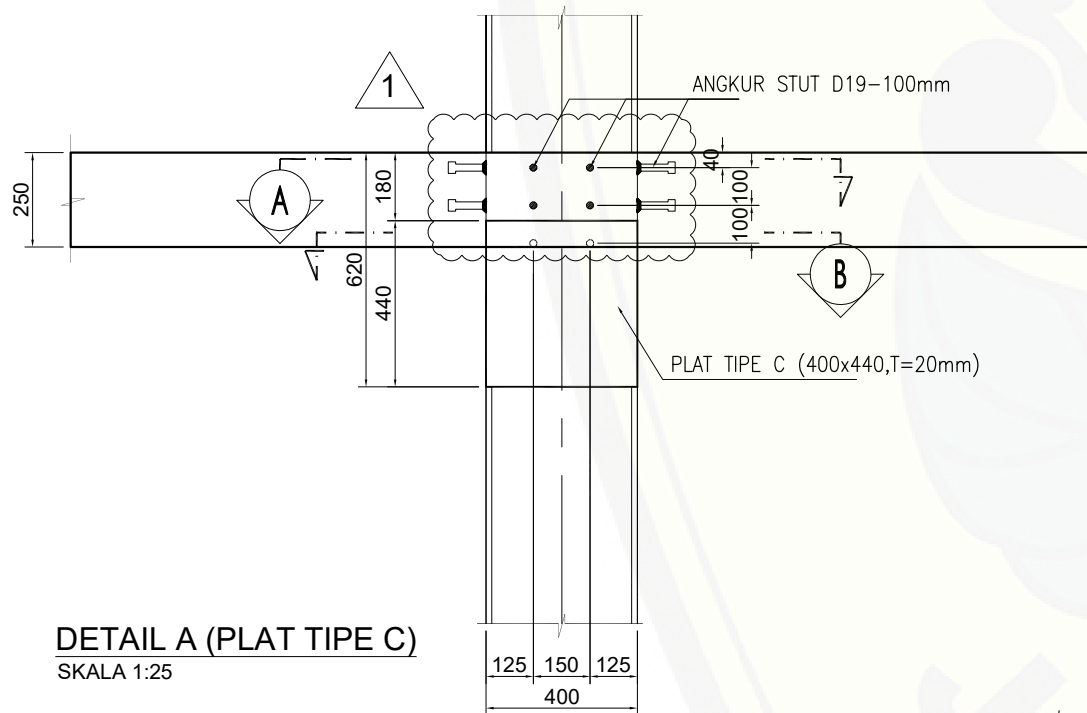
DETAIL KINGPOST TIPE 1A, 2, 3 & 4
